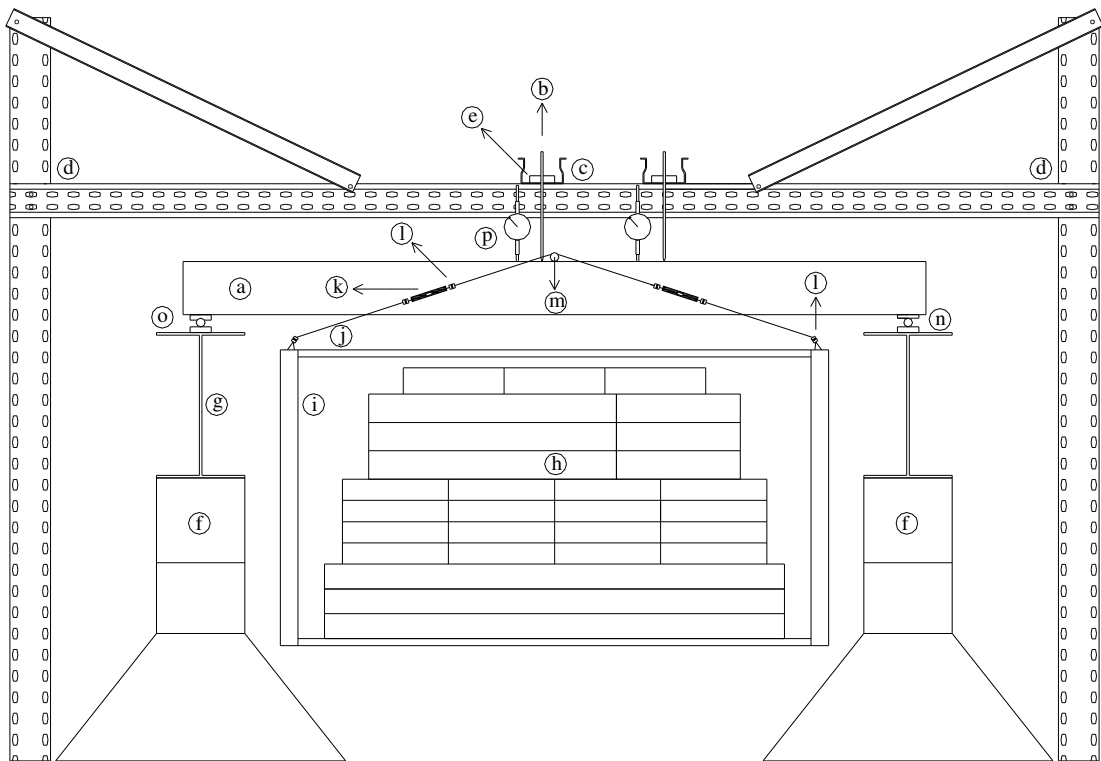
pórtico de suporte das vigas – vista frontal.
